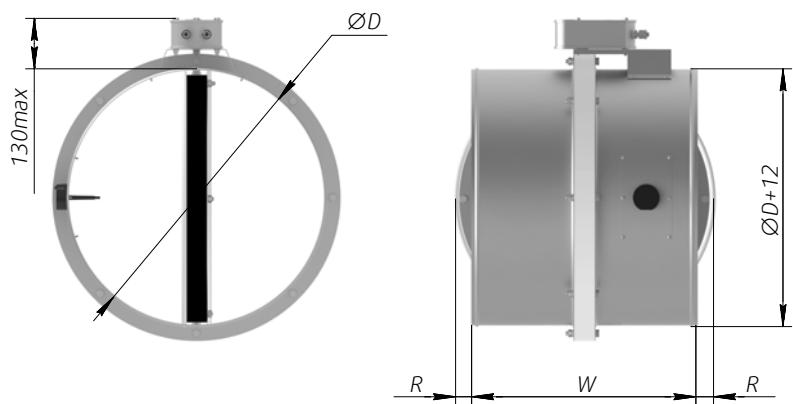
б. Размеры ниппельного клапана HELMER, EI120
